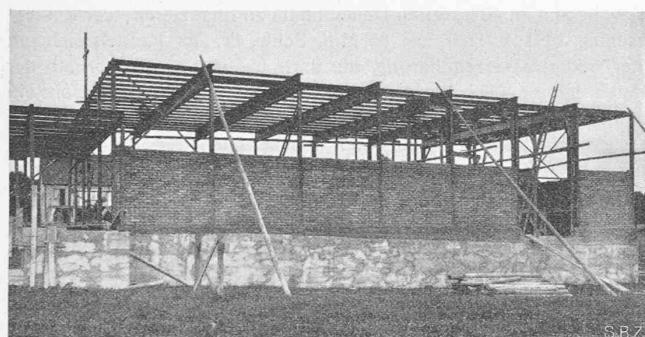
Eisenkonstruktion und Ausfachung, im Bau.
